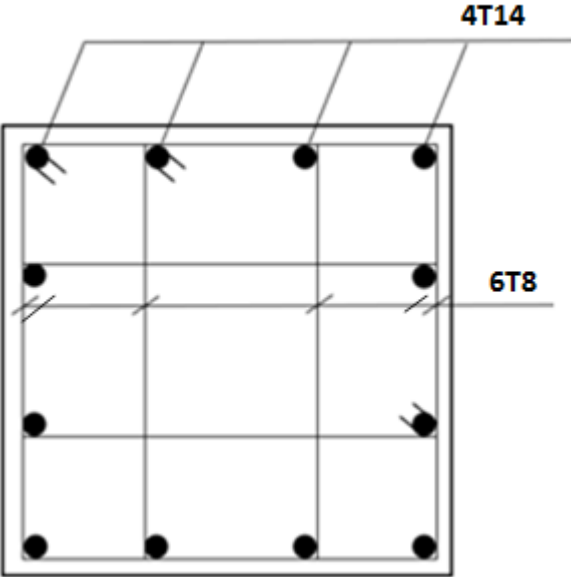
Schéma de ferrailage du poteau 45x45 (relié à un voile)
